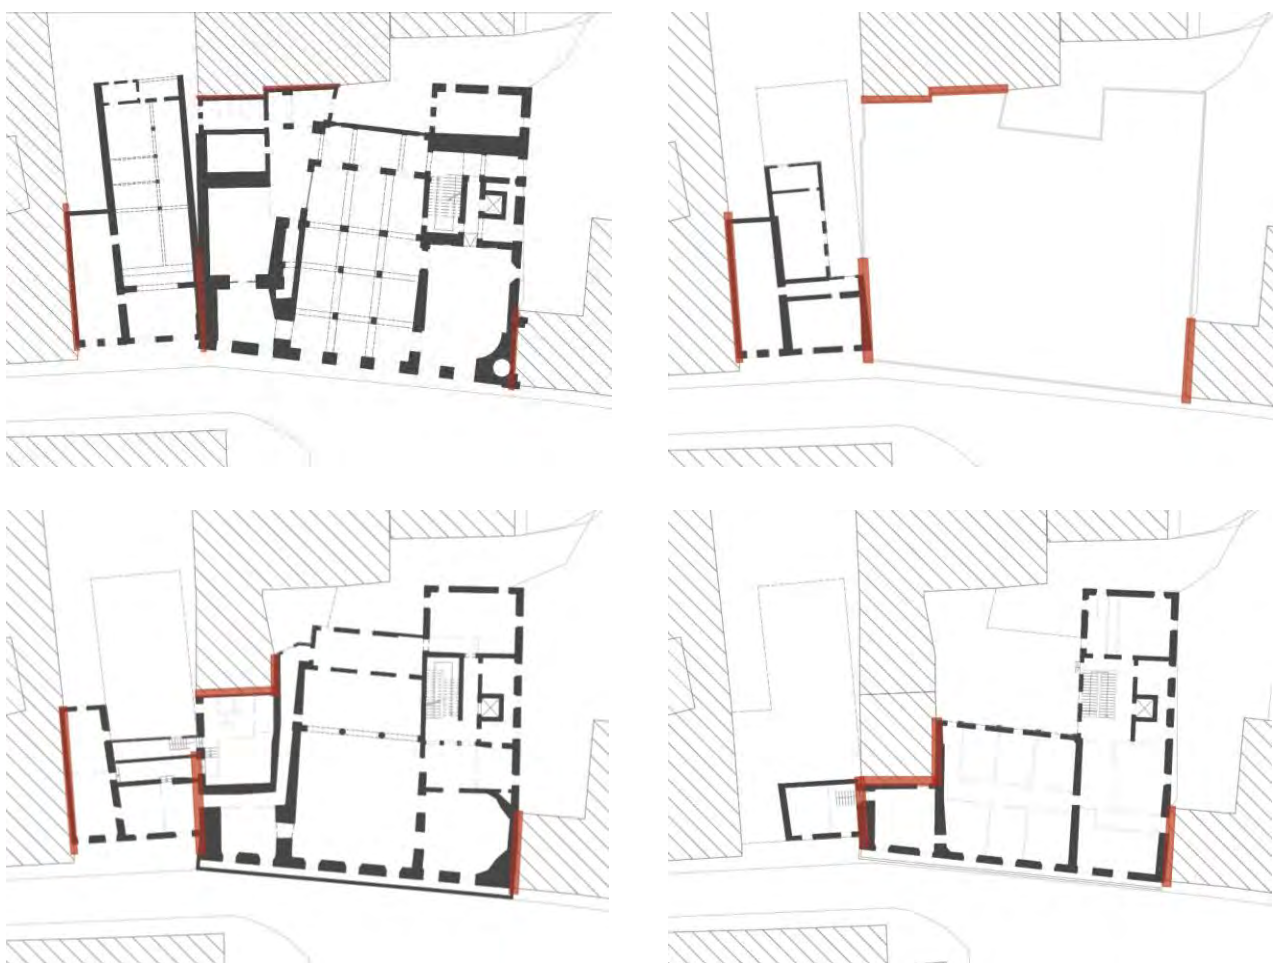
Setti vincolati del piano terra, piano ammezzato, piano secondo e piano terzo
